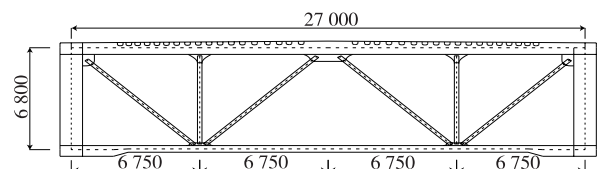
河闪渡乌江大桥钢桁加劲梁断面示意图(单位: mm)
